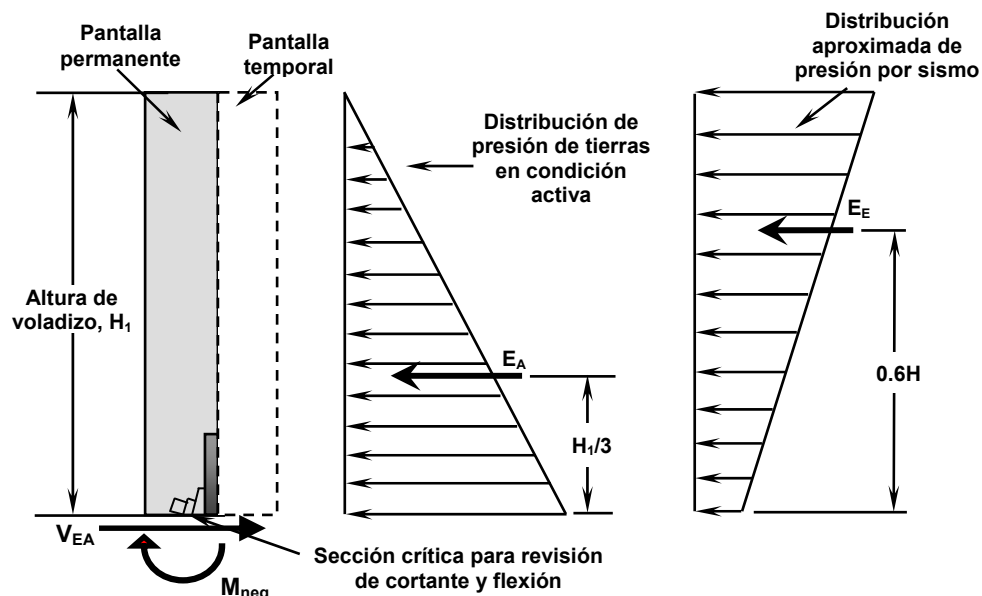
Voladizo de un muro Soil Nailing bajo condición activa más sismo.
